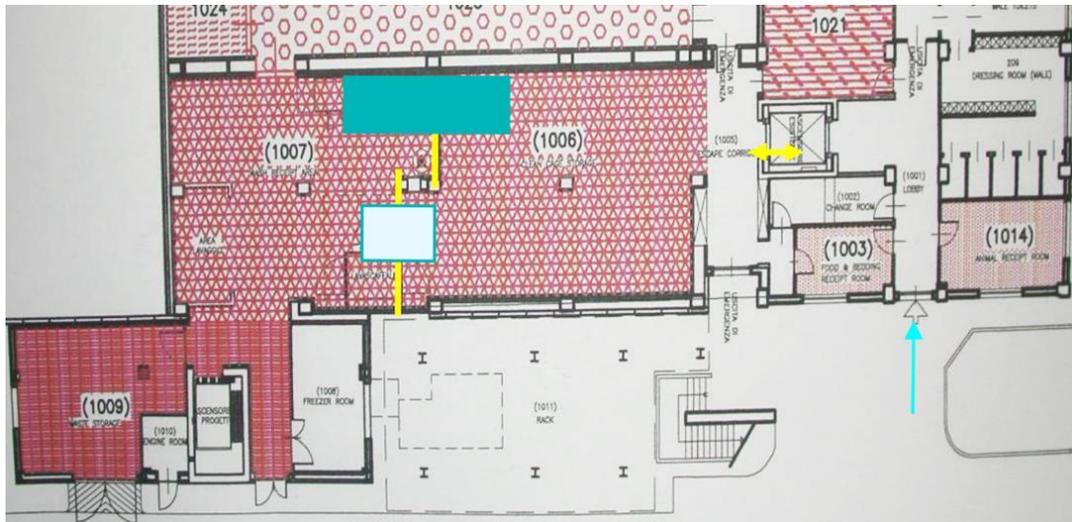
Planimetria piano terra stabilimento Pfizer Catania
